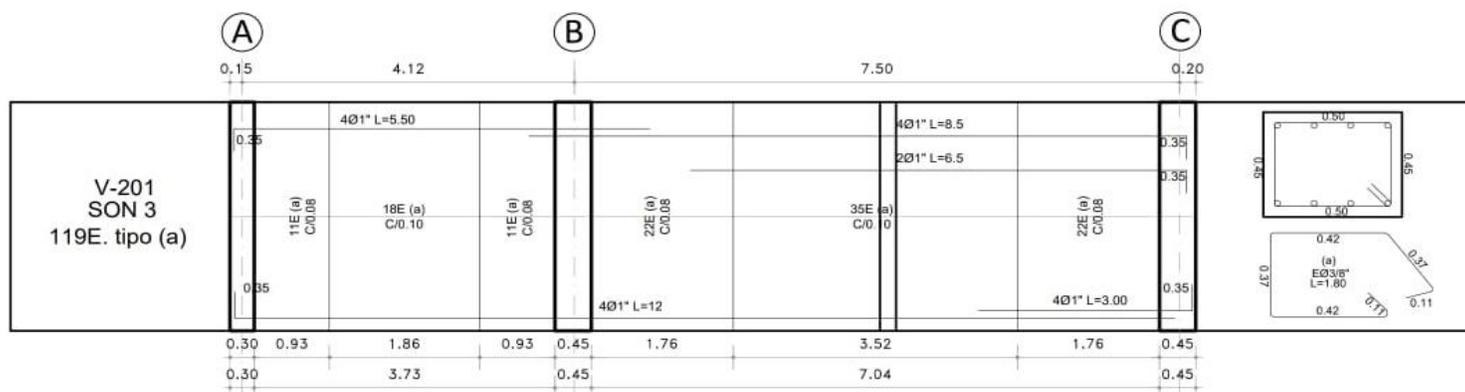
Viga 0.50x0.45 y Sección Estructural 201.
